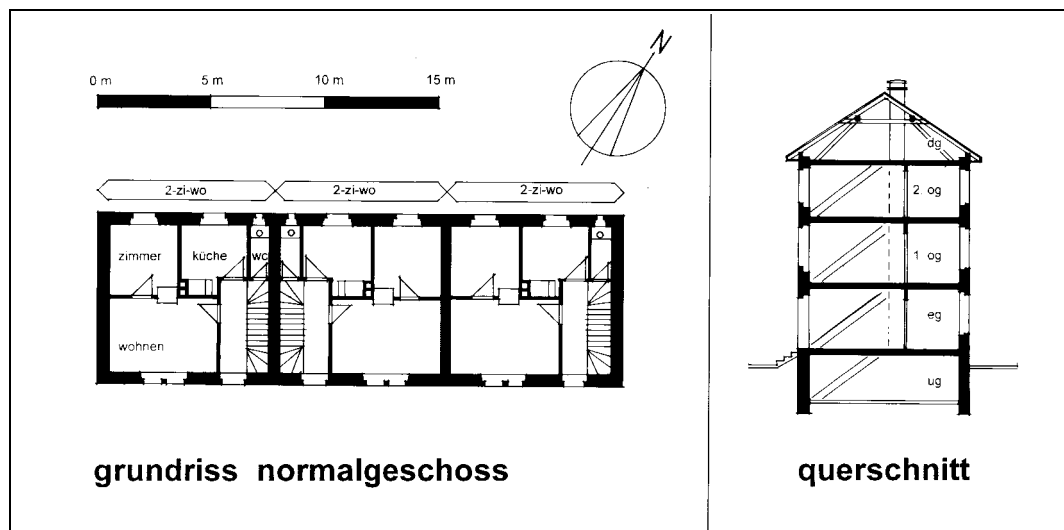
Grundriss Normalgeschoss und Querschnitt von Objekt 3.
